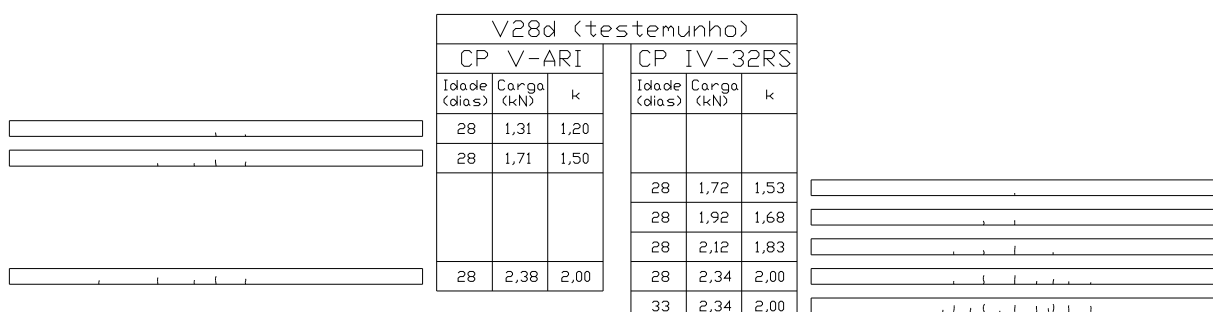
fissuras aparentes das vigas V28d (CP V-ARI e CP IV-32RS)
